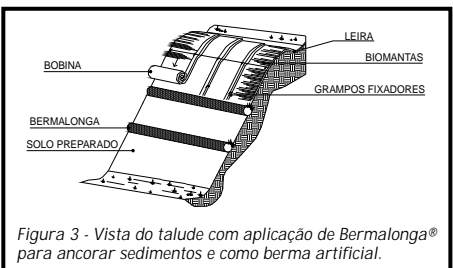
Vista do talude com aplicação de Bermalonga® para ancorar sedimentos e como berma artificial.
